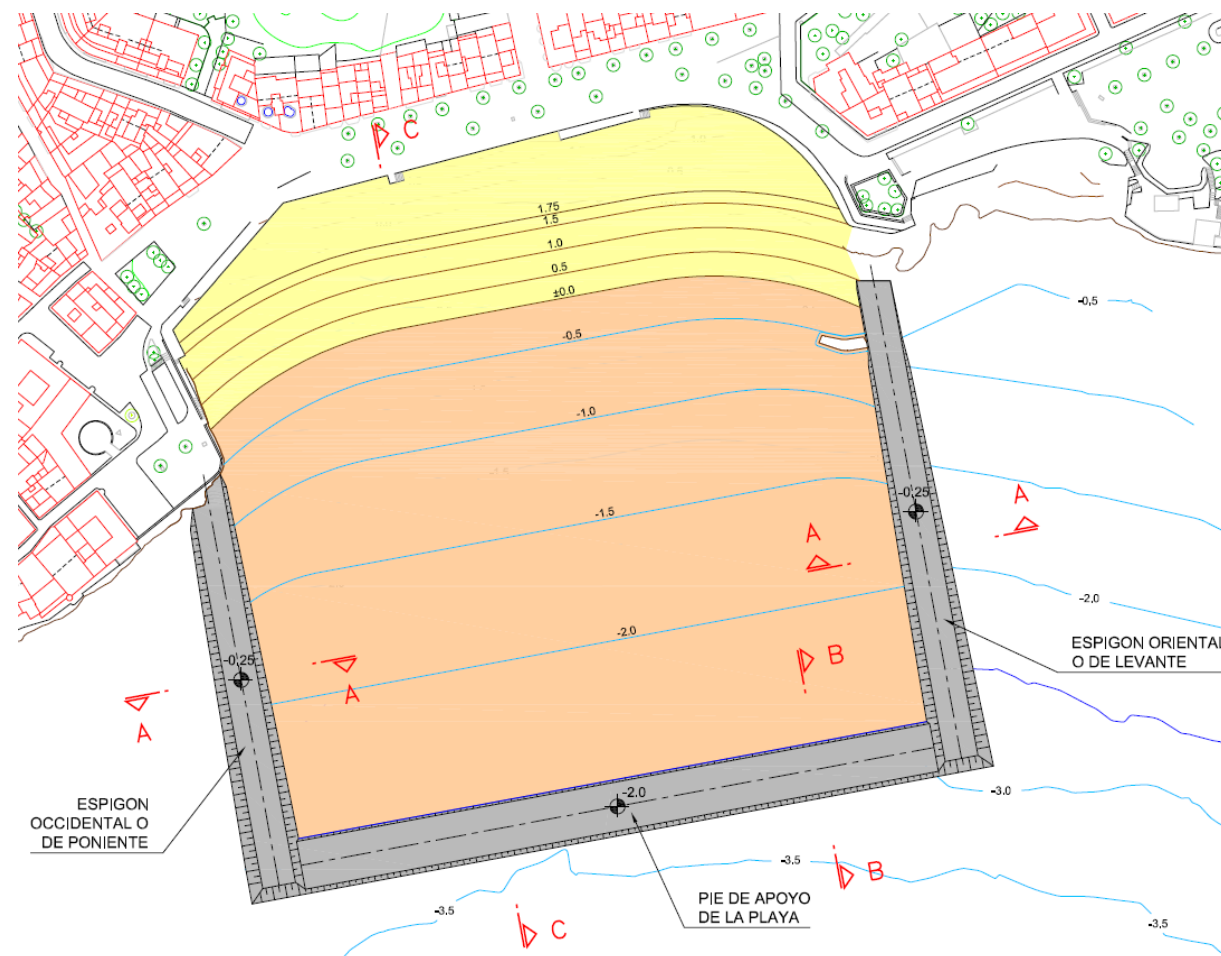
Planta de la Alternativa 4. (Fuente: Elaboración propia)
